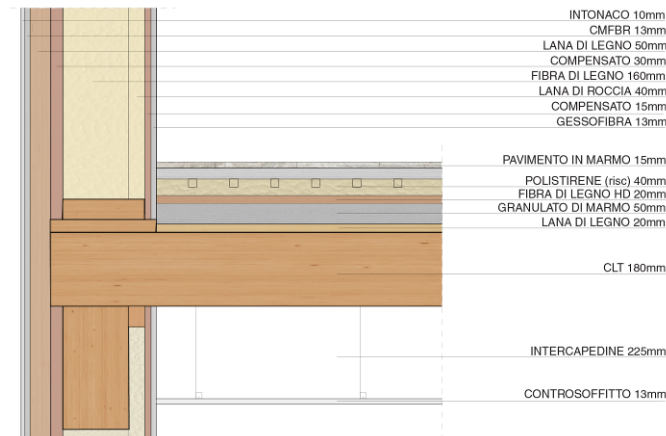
Dettaglio costruttivo del solaio interno con la parete esterna - Floor and outside wall structural junction detail.
